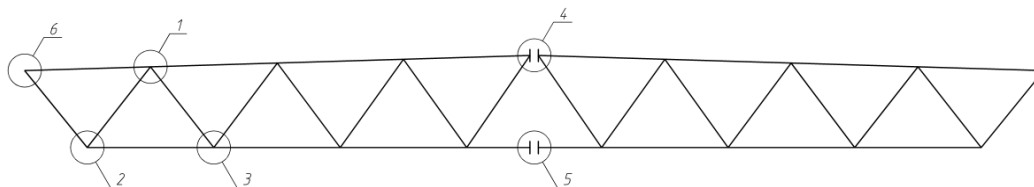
Схема расположения узлов к расчету и конструированию узлов фермы
